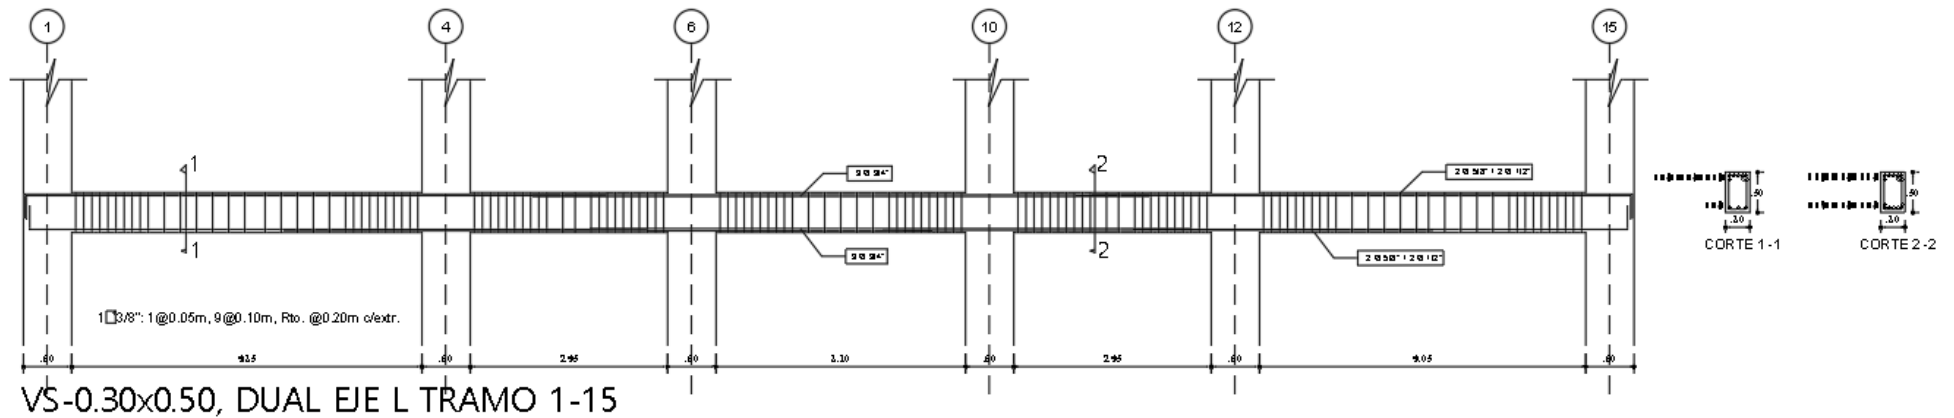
Detalle del acero longitudinal y de refuerzo de la viga secundaria, comprendido desde el eje 1 hasta el eje 15, de la losa Vigacero de concreto convencional  $f'c=280\text{kgcm}^2$ .
